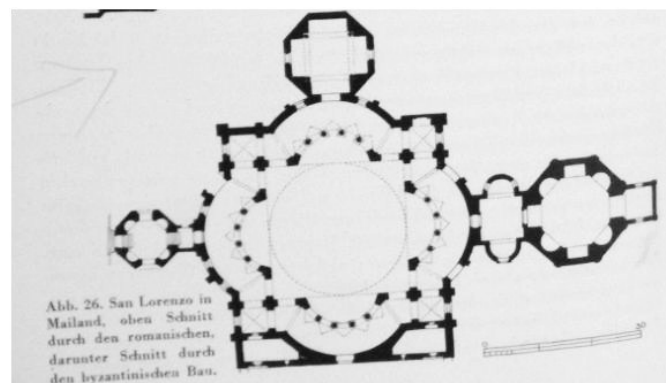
Grundriss, San Lorenzo, Mailand, 360-420.
